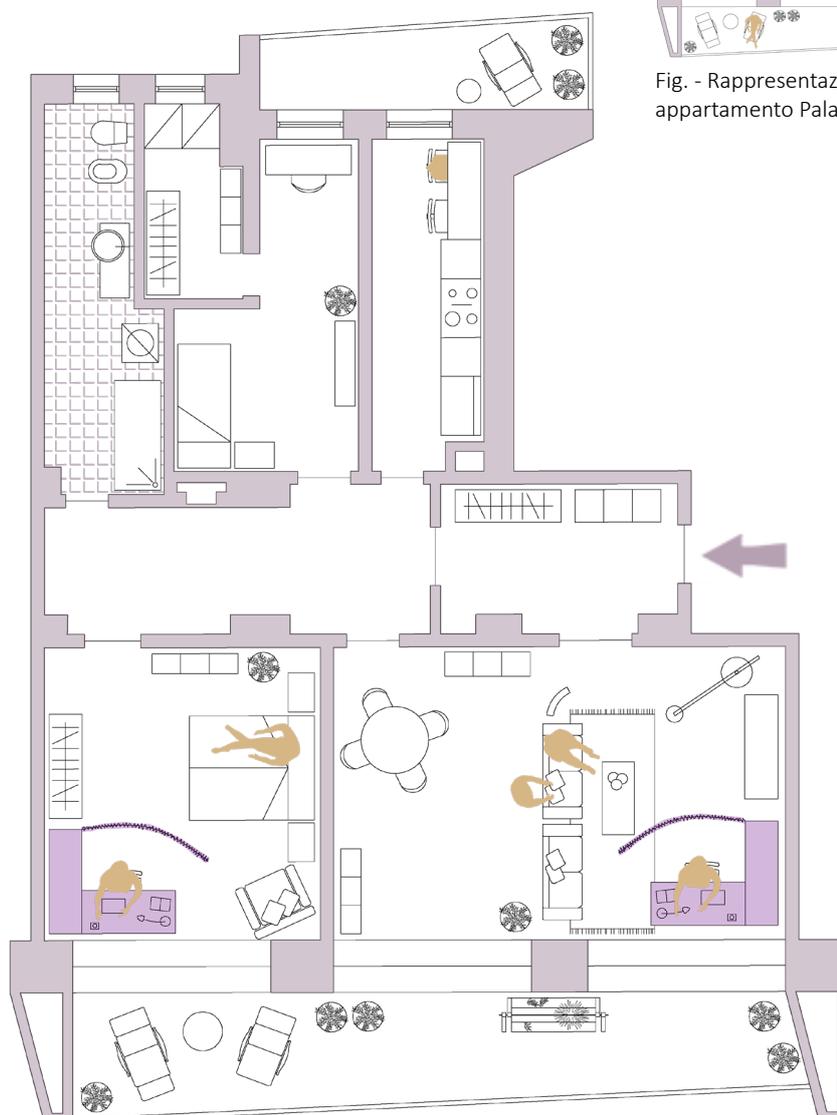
Rappresentazione planimetrica soluzione ambiente studio / lavoro in due zone diverse della casa.
